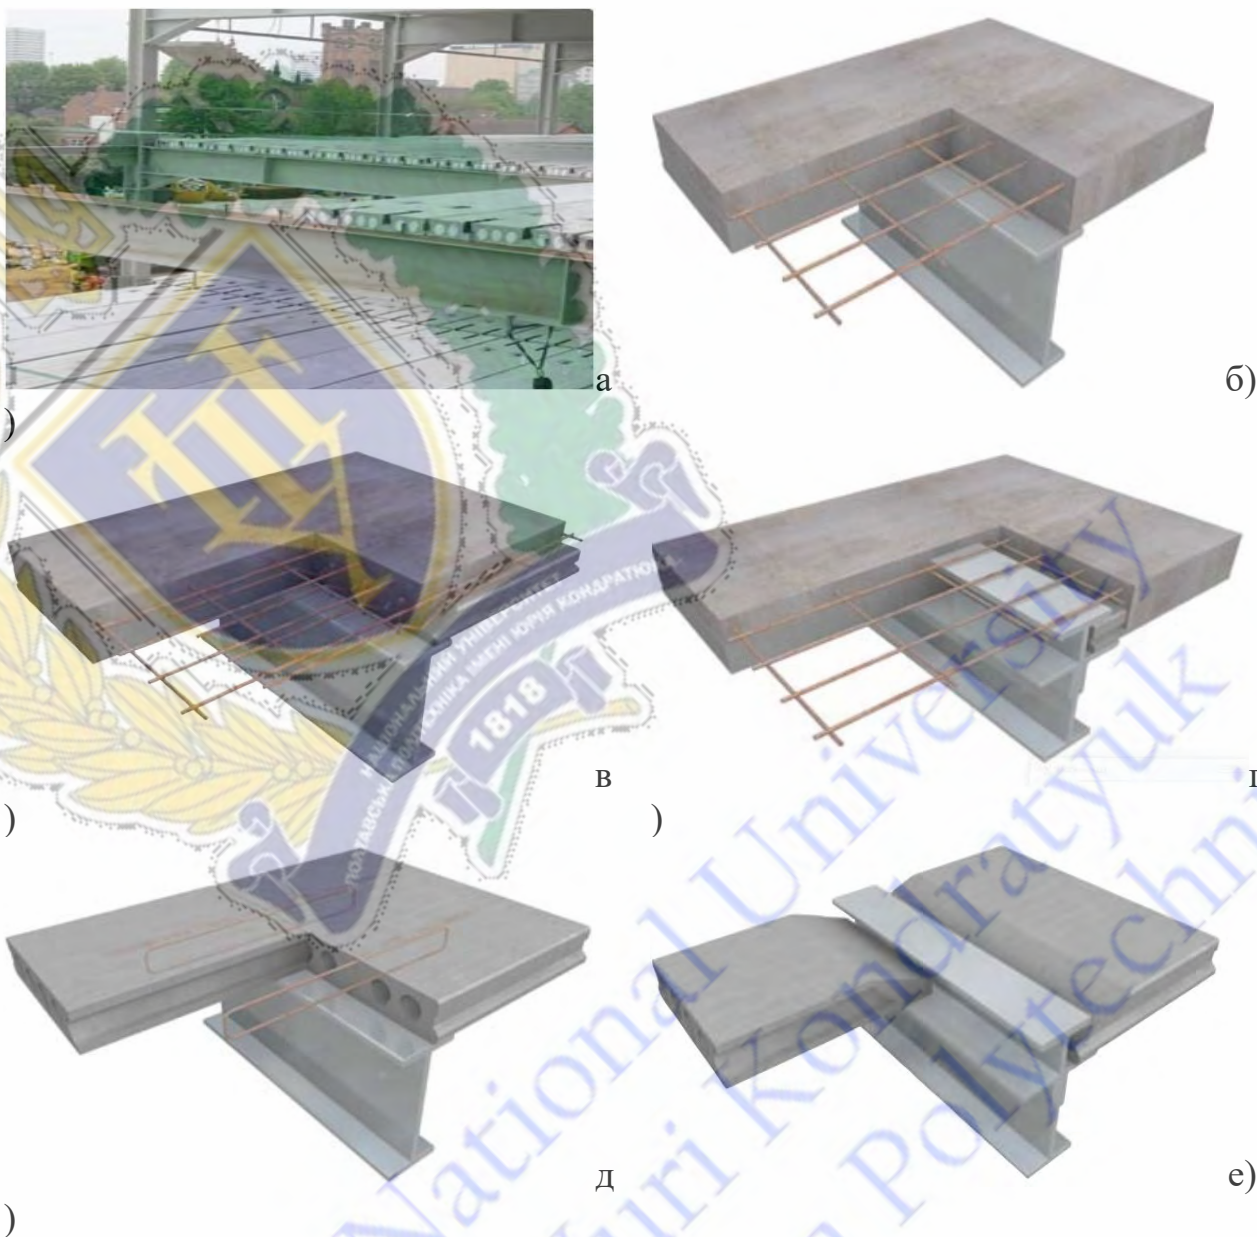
Комбіновані сталезалізобетонні балки із конструкційного сталюого профілю та збірно-монолітних залізобетонних полиць: а) загальний вигляд перекриття із збірних плит по сталюим балкам; б) комбінована балка з монолітною залізобетонною плитою; в, г) комбінована балка із двошаровою збірно-монолітною плитою; д) комбінована балка із полицею, яка улаштована із збірних порожнистих плит з тупим кінцем; е) комбінована балка із полицею, яка улаштована із збірних порожнистих плит з частково похилим кінцем.
